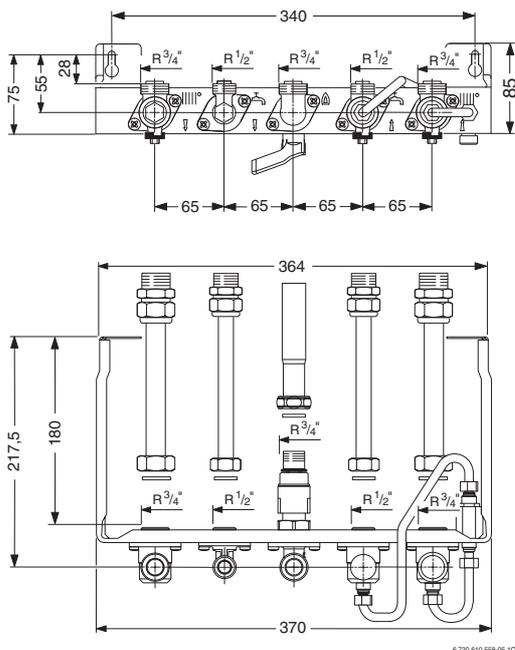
Quote piastra di preinstallazione DOS GA 5
